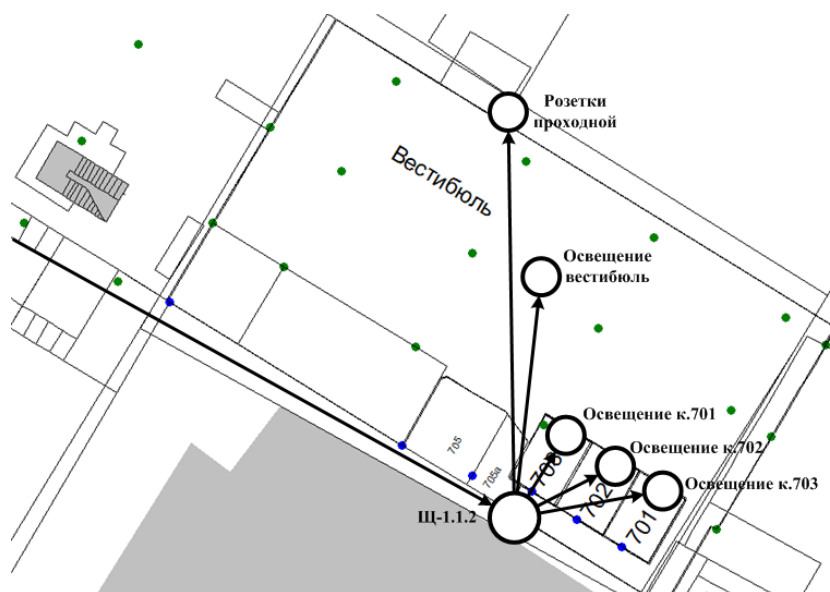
Фрагмент поэтажного плана здания с размещенными на нем объектами электроснабжения
